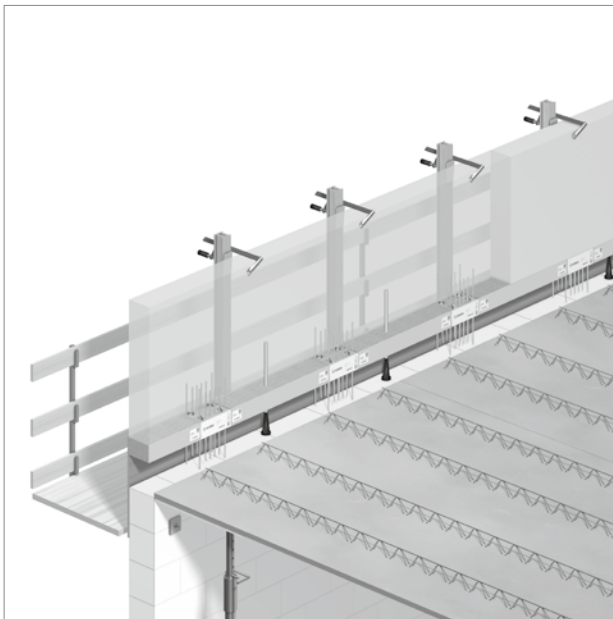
Schöck Isokorb® CXT Typ AP mit Combar® Element-Montagestütze: Fixieren der ausgerichteten Elementattika
